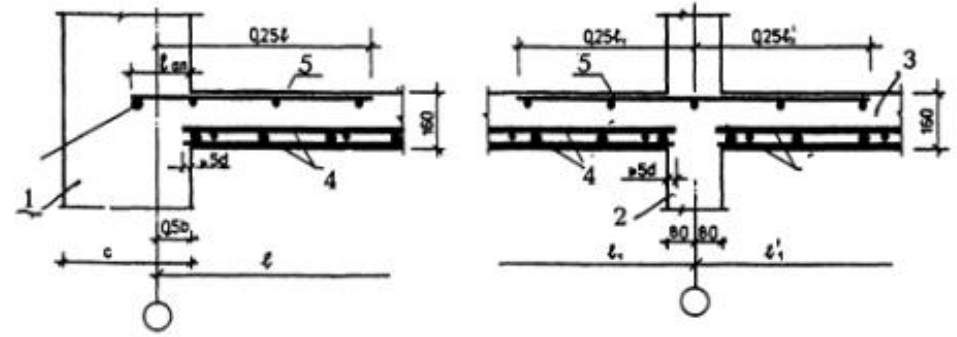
Монолитные неразрезные перекрытия, защемленные в наружных и внутренних стенах при контактных сопряжениях: 1 - наружная стена; 2 - внутренняя стена; 3 - монолитная плита перекрытия; 4 - нижнее армирование; 5 - верхнее армирование (на опорах)
